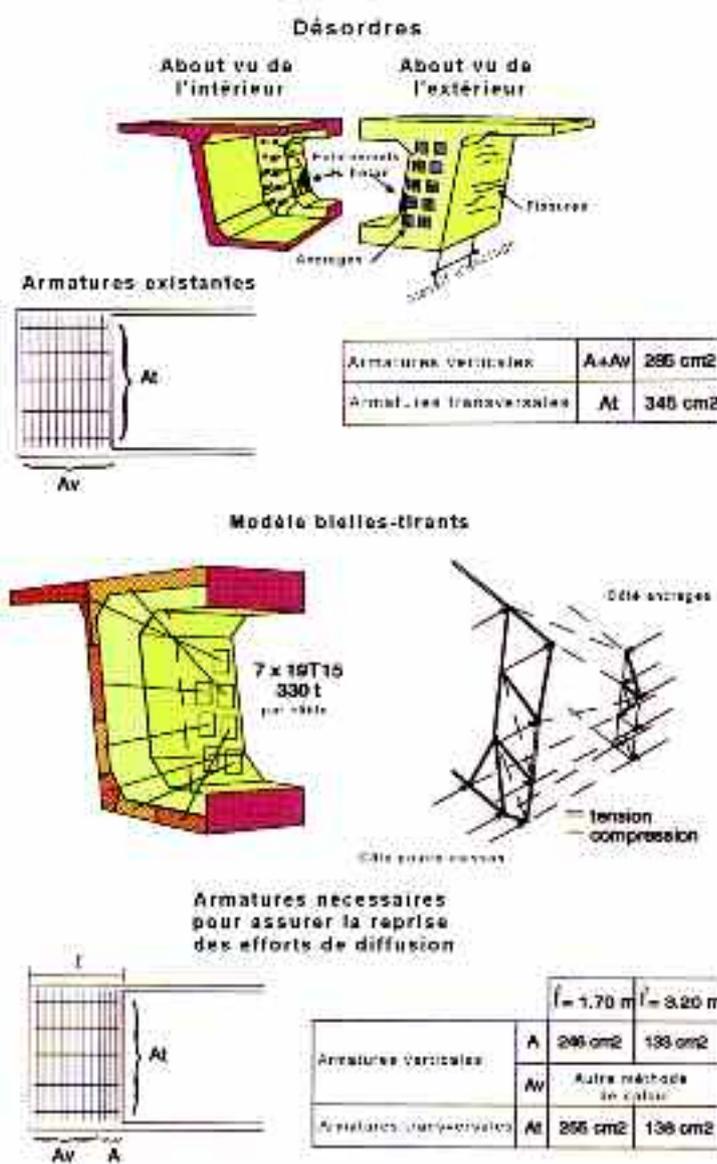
désordres à l'about d'une poutre-caisson lors de la mise en tension des câbles ancrés à ce niveau
